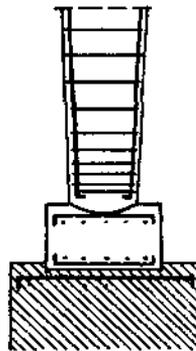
Заделка железобетонной стойки на фундаменте.
